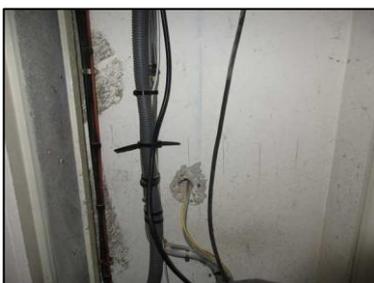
ECH-N°017 RdC mur armoire électrique Peinture + béton
